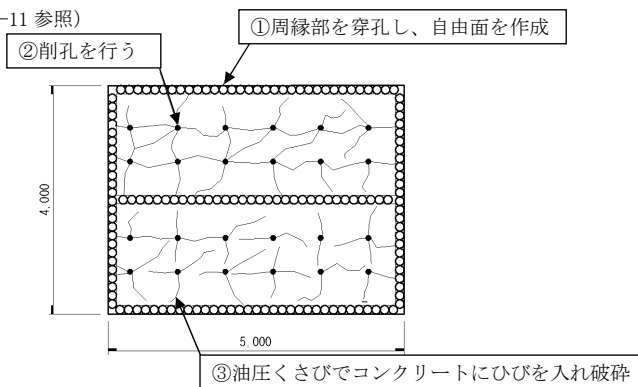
水位低下設備放流工破碎工法概要（下流面）図
